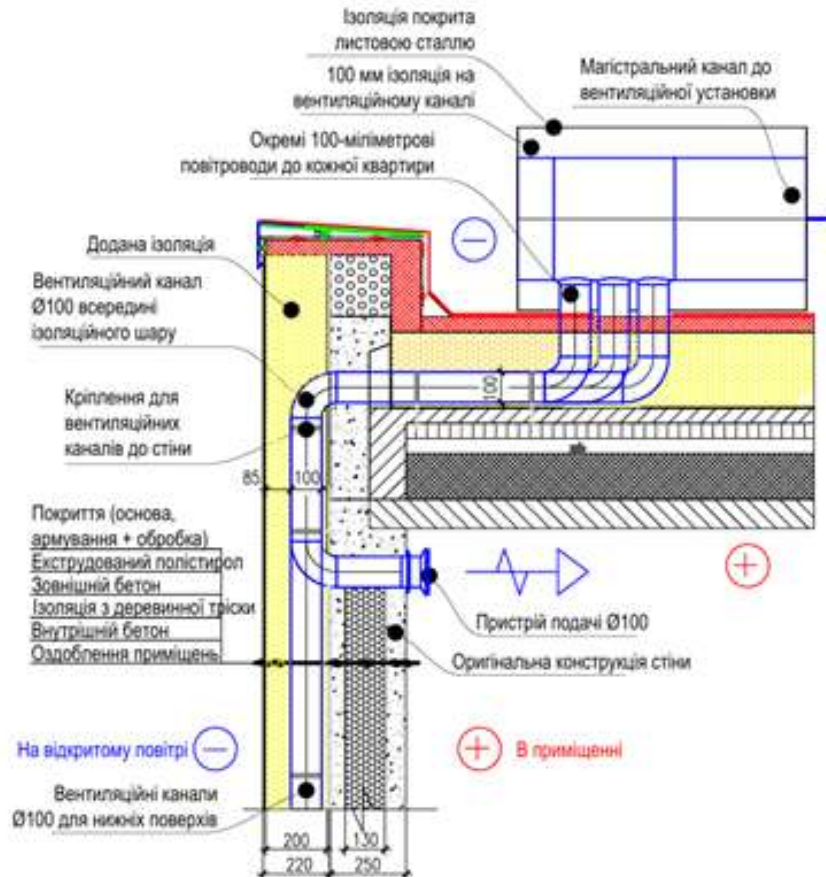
Розріз системи з вентиляційними каналами всередині фасаду будівлі
